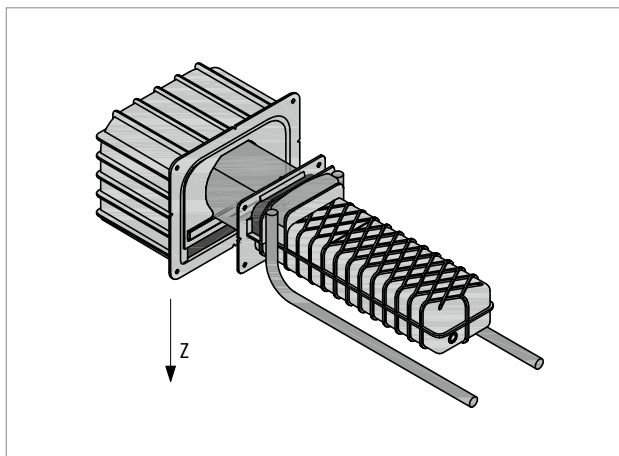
Tronsole® Q: 3D-Ansicht mit Achsbezeichnung
